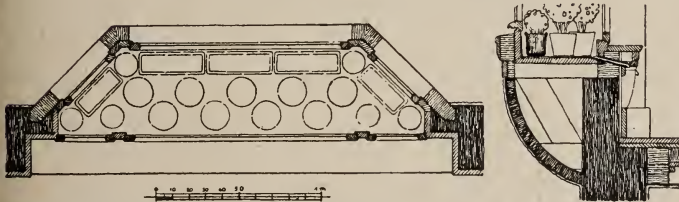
und 99. Blumenfenster. Grundriß und Schnitt
